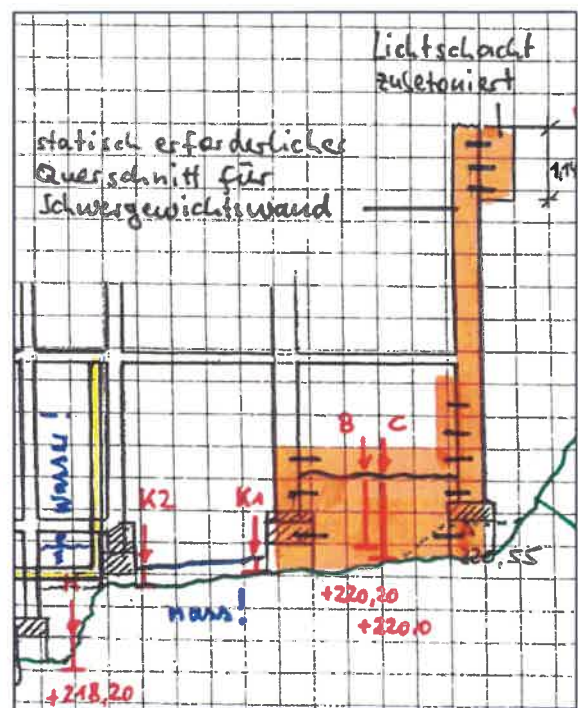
zubetonierter Keller und Lichtschacht in Höhe von Schnitt 2-2
